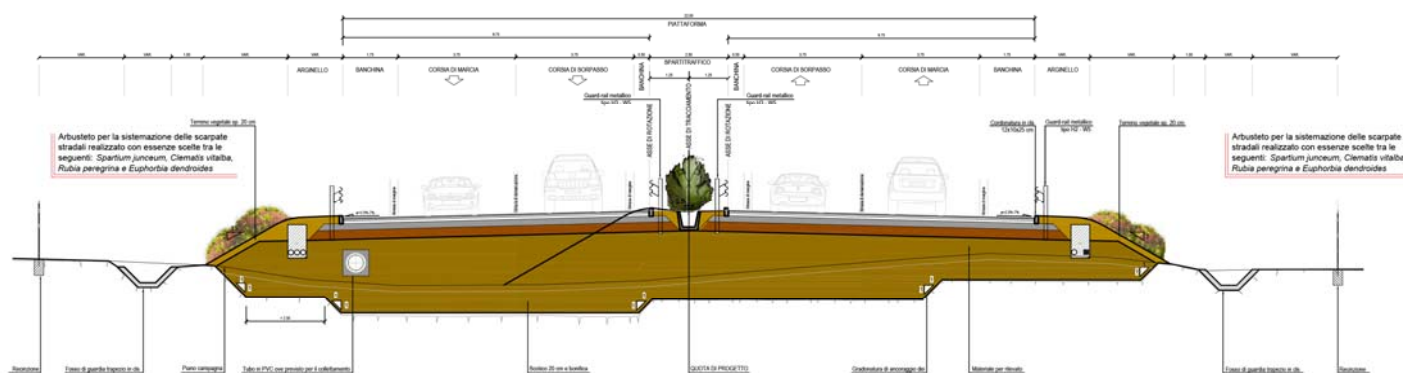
Sistemazione a verde lungo il rilevato stradale
